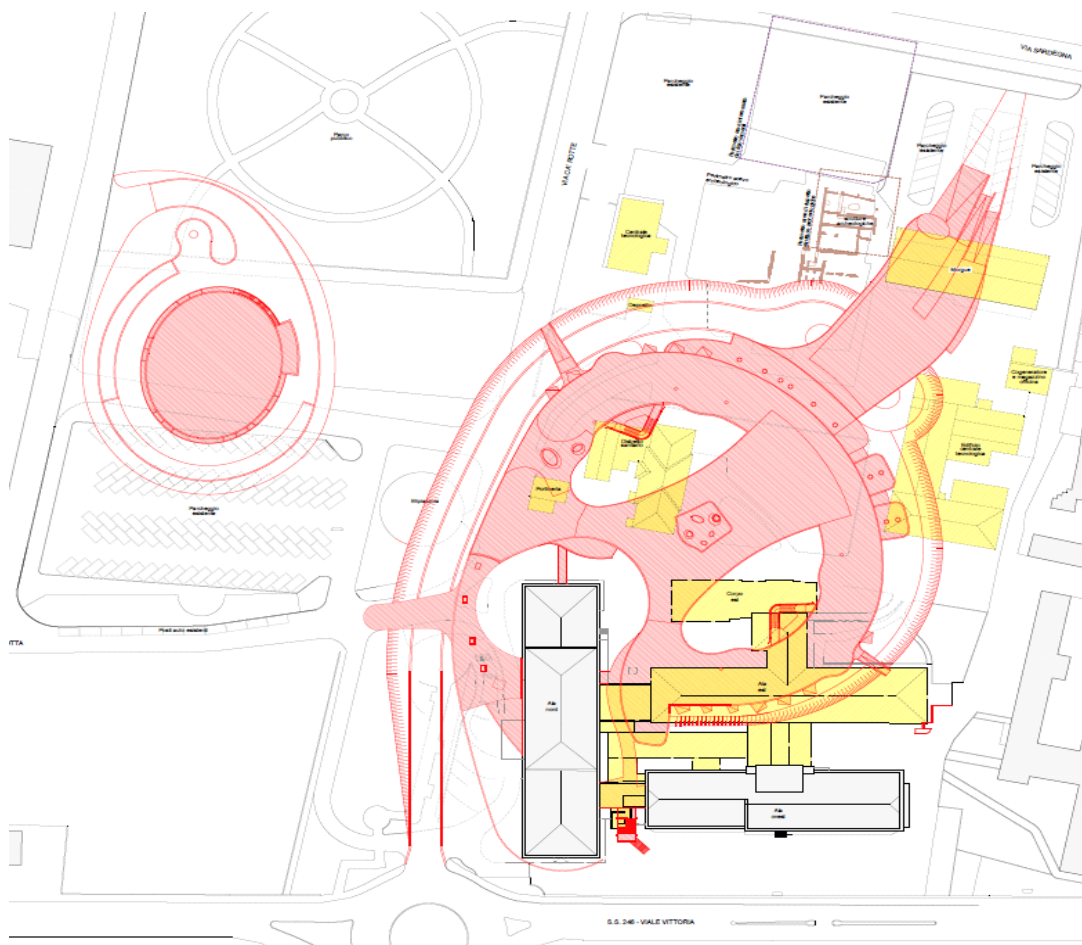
Planimetria con indicazione delle demolizioni e realizzazioni
